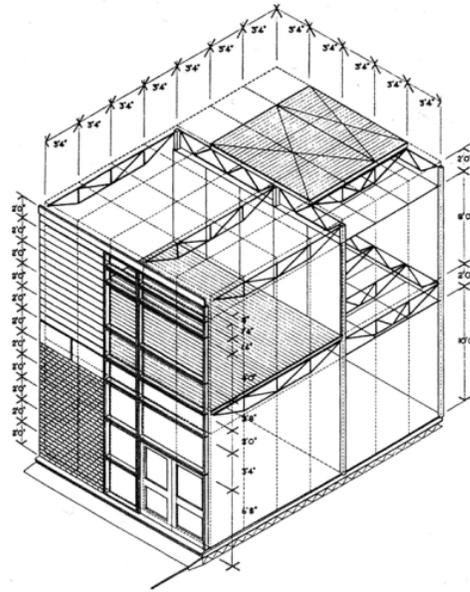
Módulo estructural del Sistema Constructivo Prefabricado CLASP.
